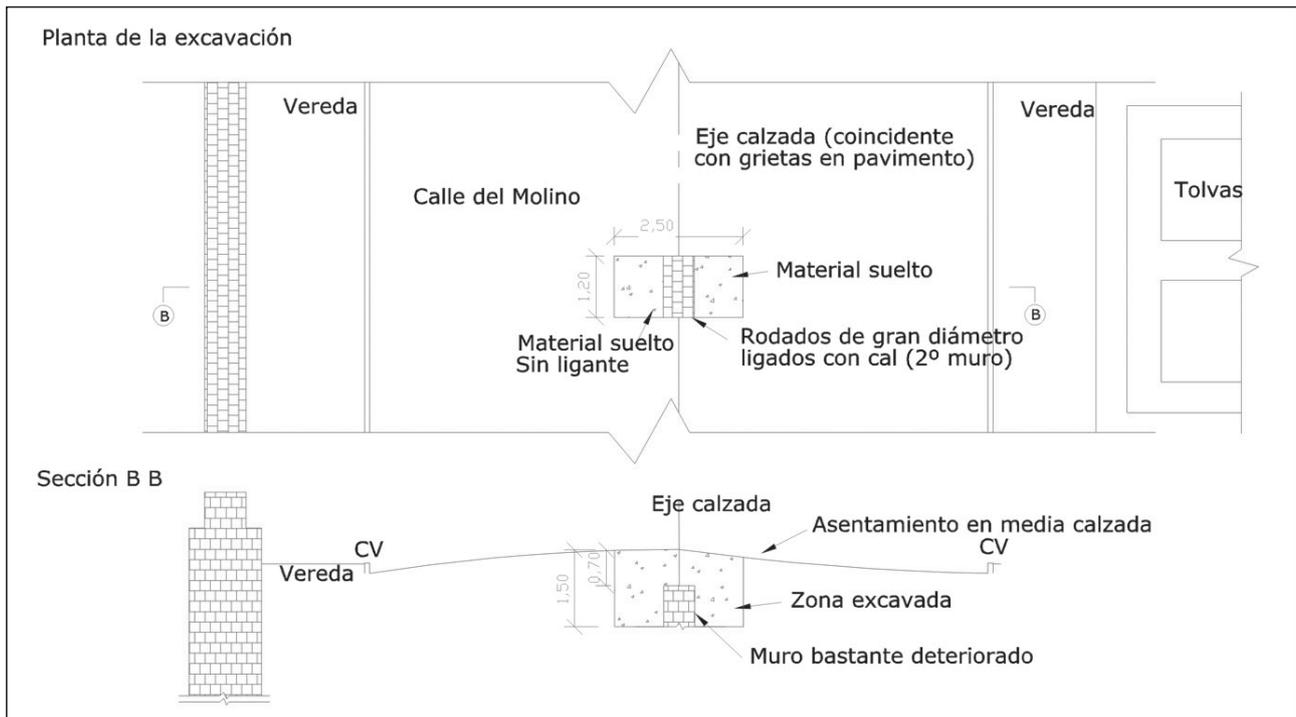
Esquema de ubicación en planta y corte de la zona de excavación
